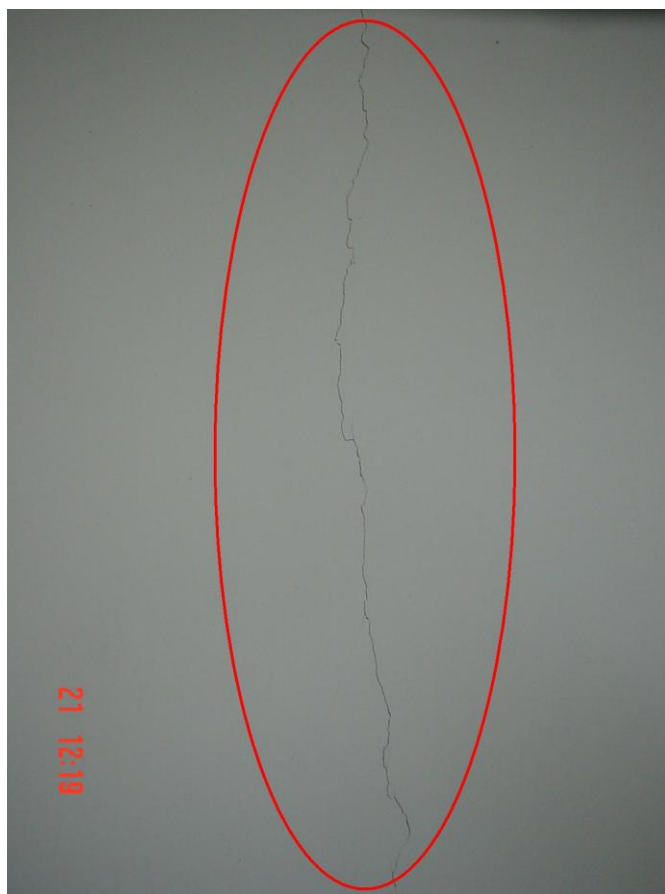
DETERIORO Y FISURAS EN PARED LATERAL IZQUIERDA
